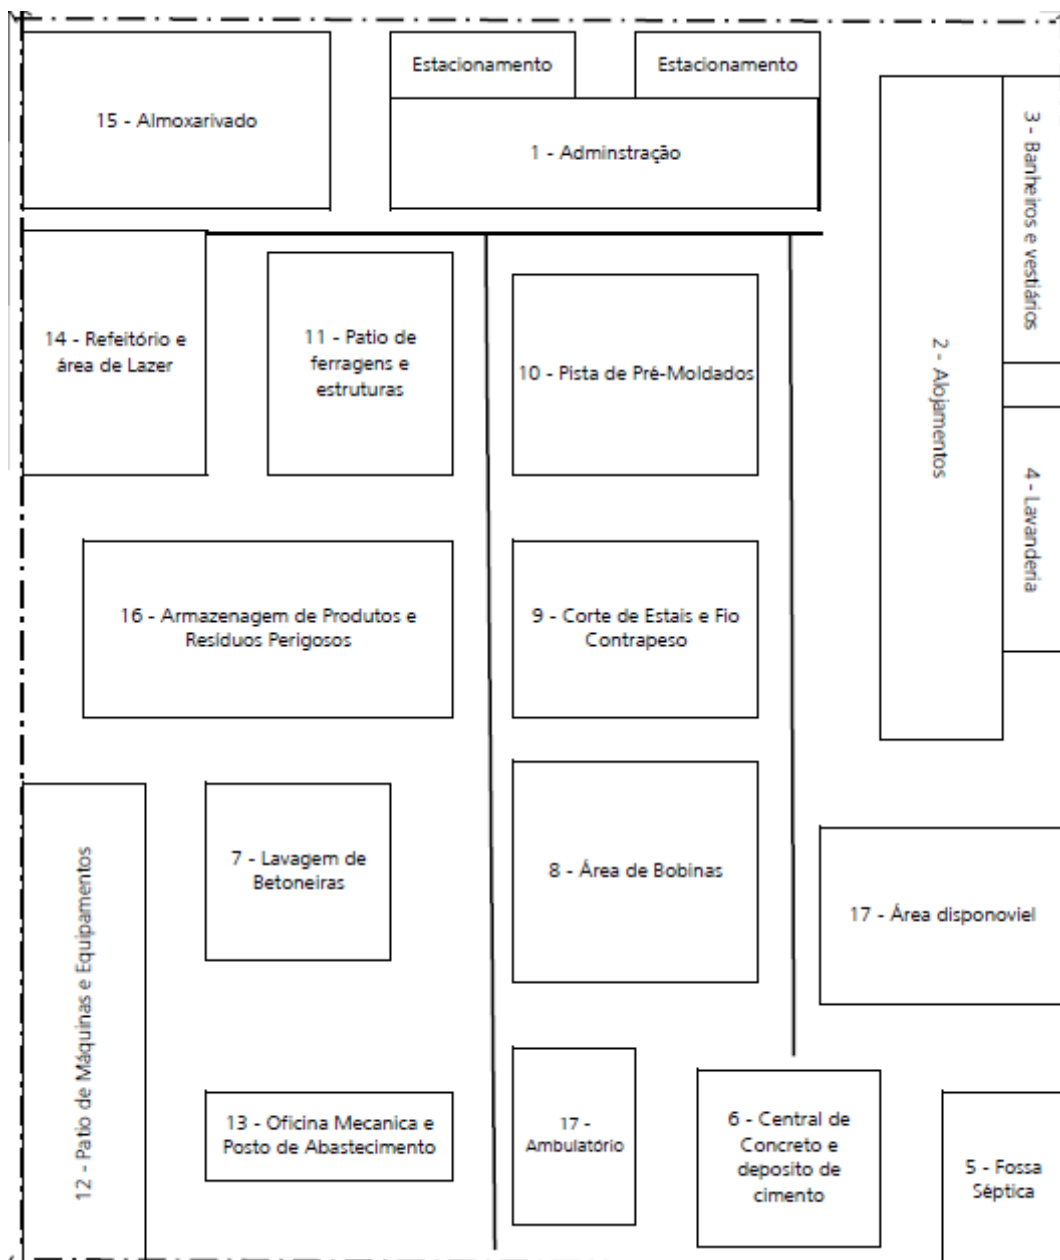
Layout típico do Canteiro de Obra da LT (Fonte: ATE XVII, 2013).
